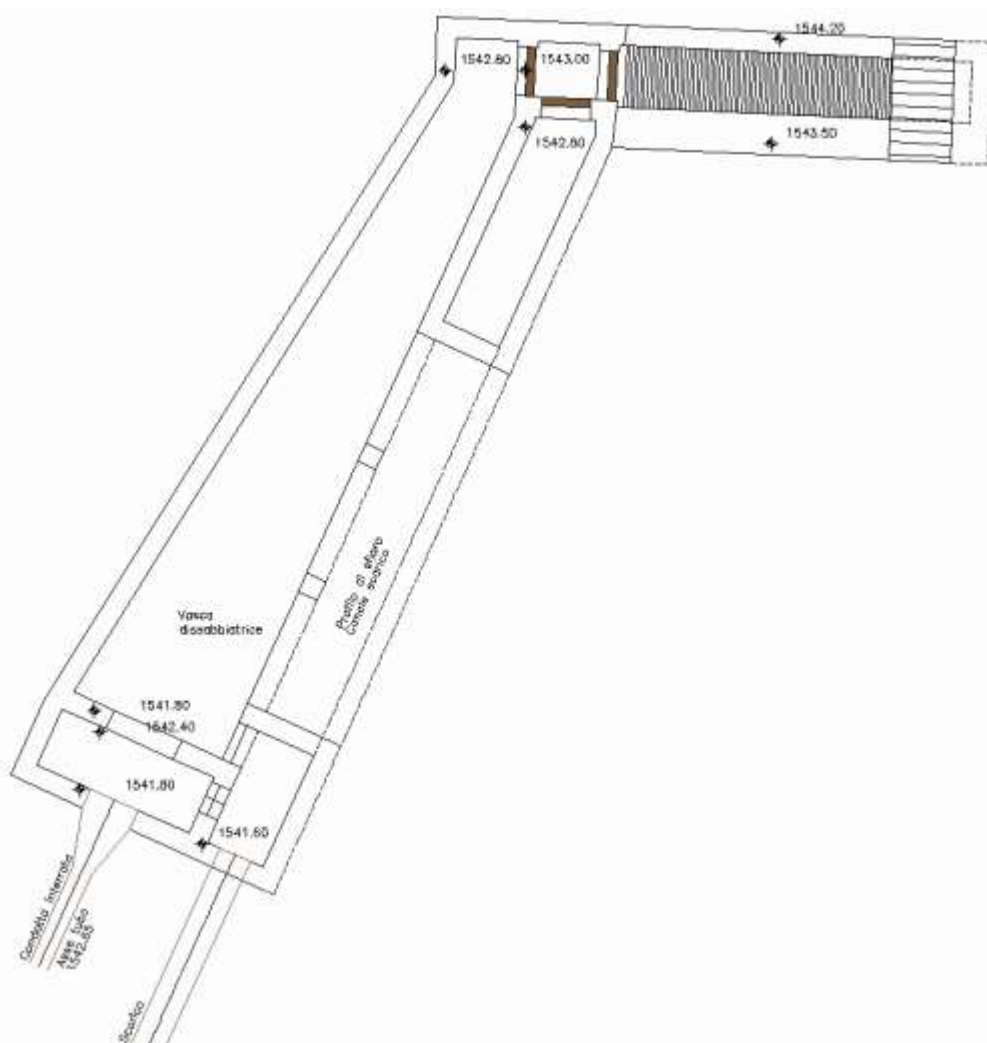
Planimetria di progetto dell'opera di presa, della vasca di decantazione e di carico in posizione adiacente rispetto all'alveo del torrente Planaval.
